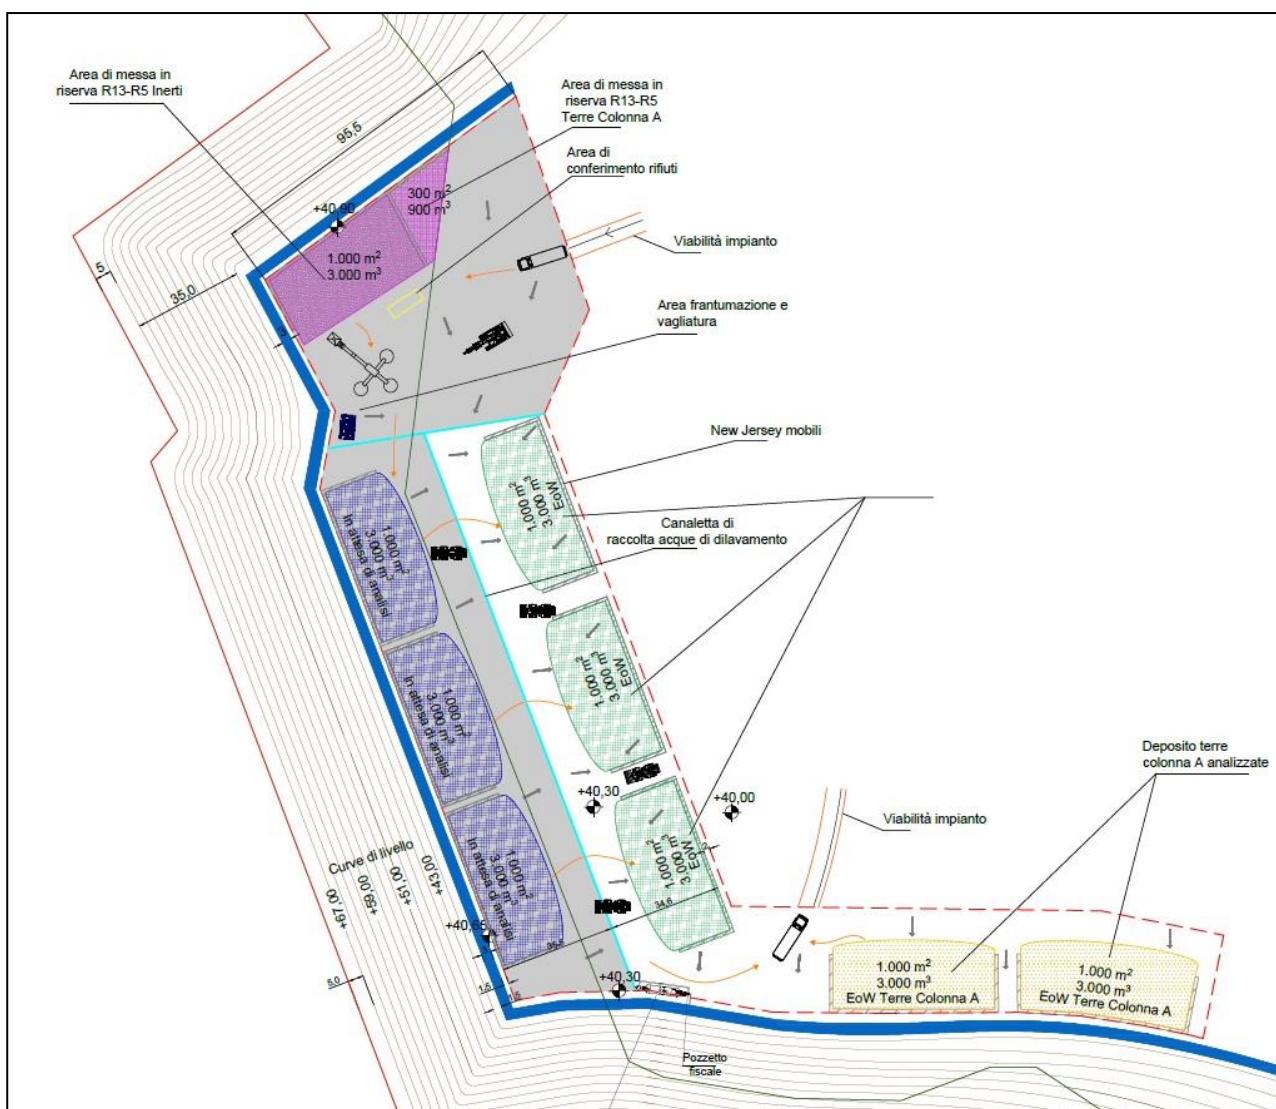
Layout impianto con aree di lavoro – Estratto Tavola 4
